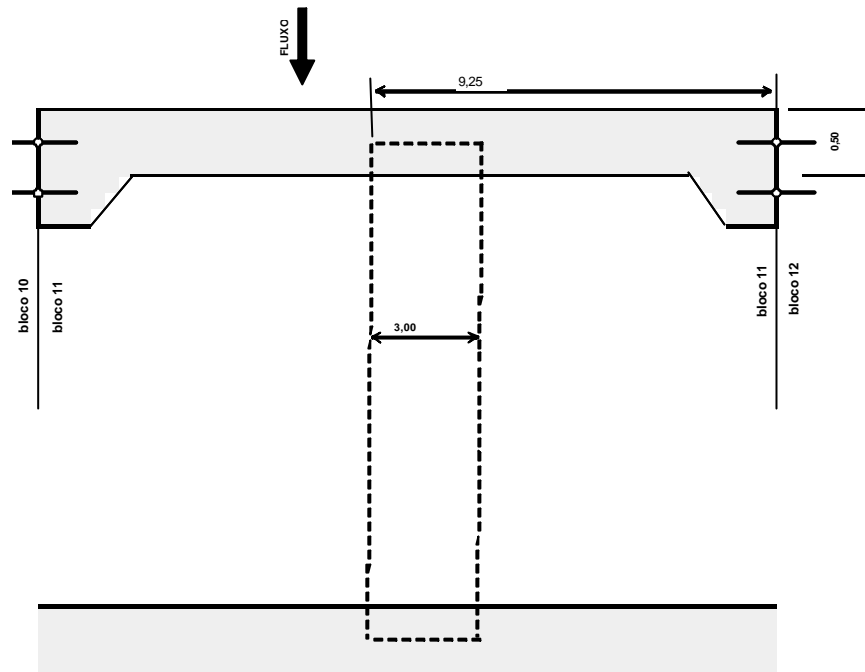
CROQUI EM PLANTA DA SEÇÃO TIPO DE INSTALAÇÃO DO TFOR
